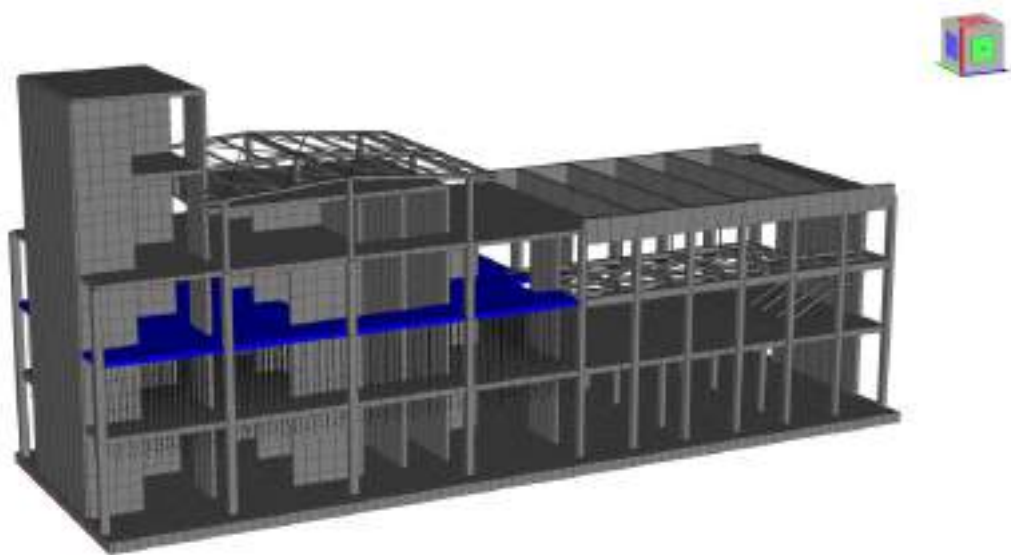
implementazione del carico pacchetto pavimentazione L1 – $g_k = 3.60 \text{ kPa}$.
